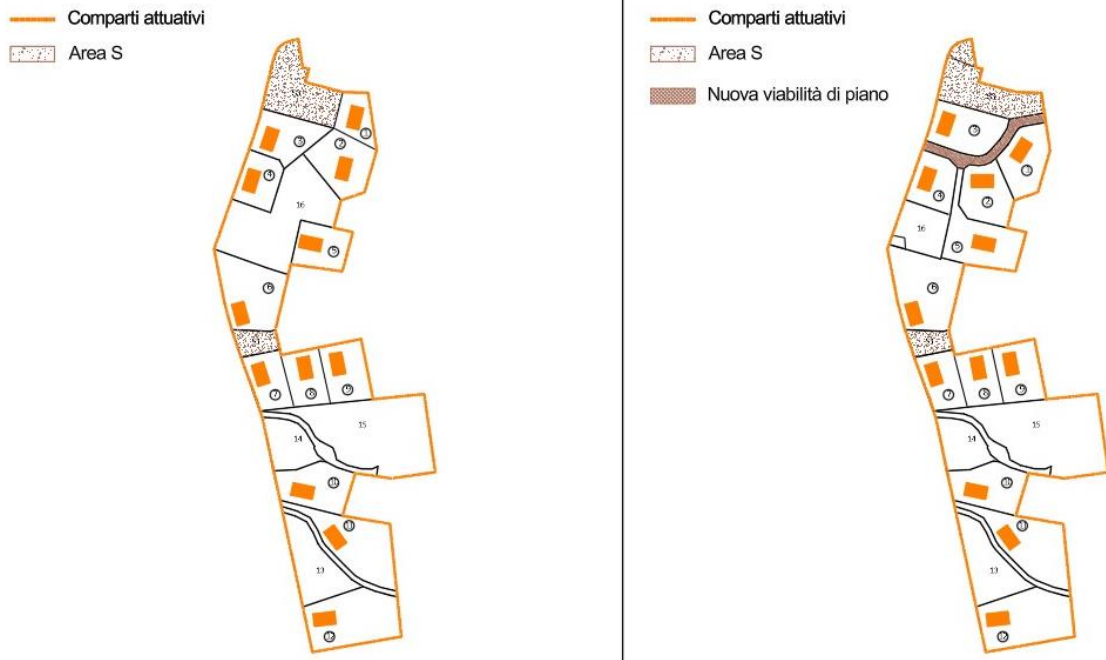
Planimetria comparativa Cb3 – Stato di fatto - Variante
